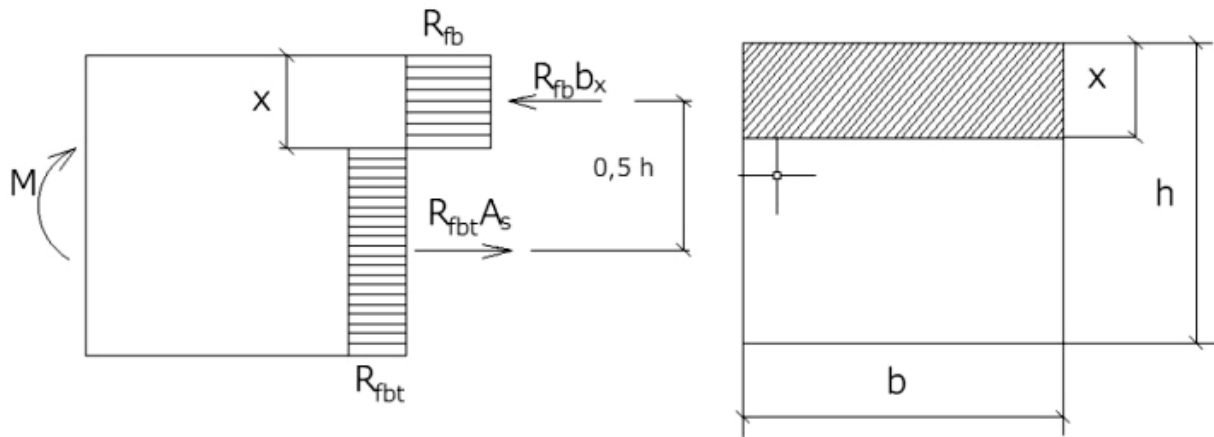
Эпюра напряжений и схема приложения нагрузки в расчетном сечении изгибаемой фибробетонной балки, при расчете по прочности (при фибровом армировании)
